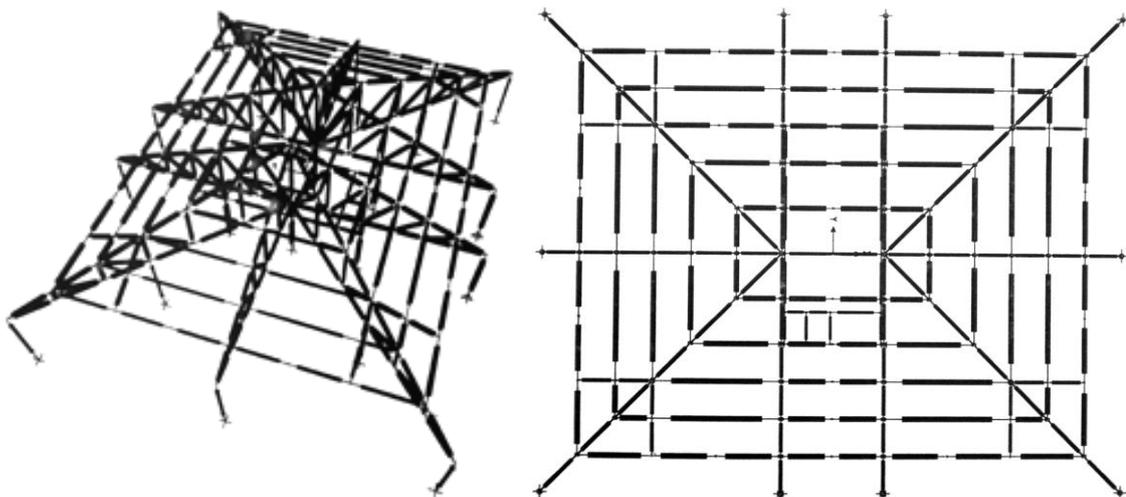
Fotos digitais: 3D e planta da estrutura metálica gerada pelo programa SAP 2000.
